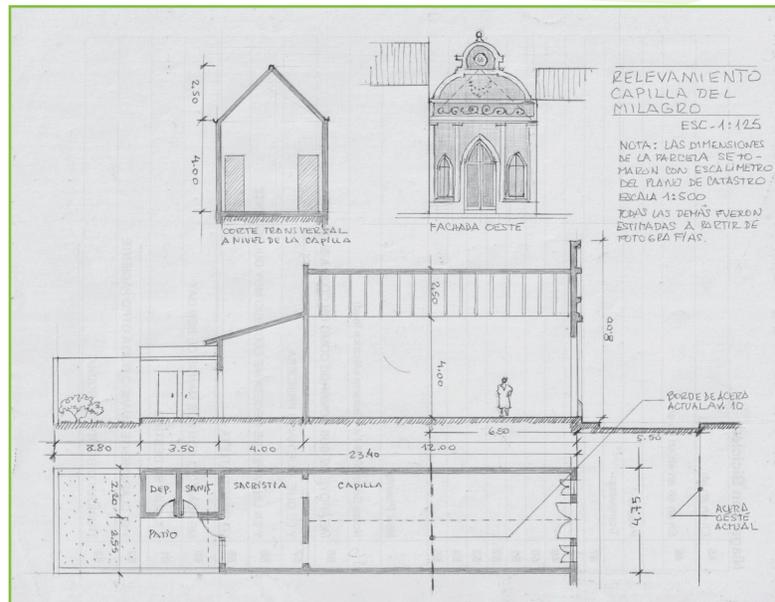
Croquis. Reconstrucción de planta, cortes y alzado de la Capilla para 1969.
